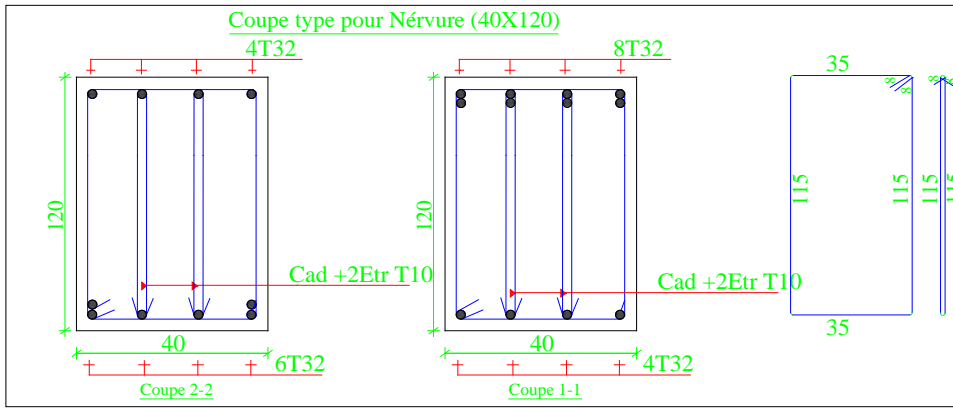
ferrailage coupe en travée et appuis selon x-x et y-y
